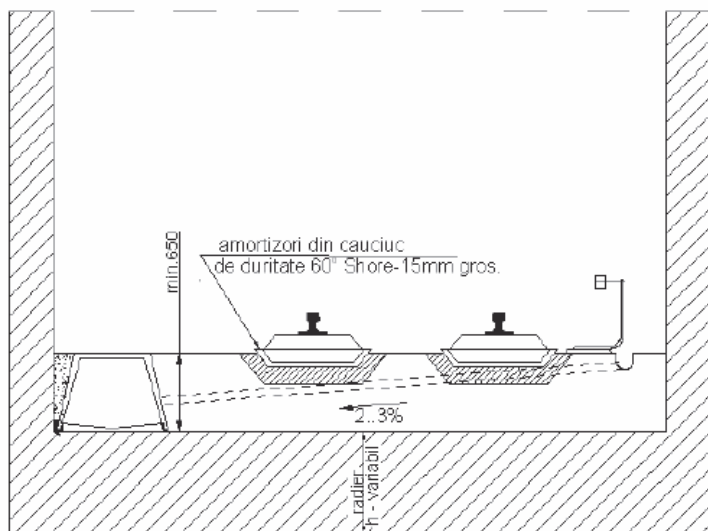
Detaliu de amplasare a șinelor de metrou pe blocheți de beton
